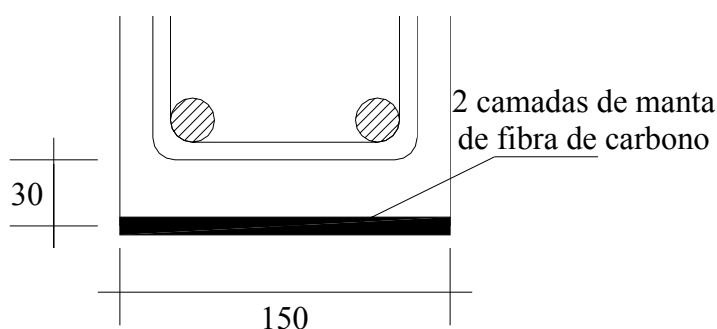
Detalhamento do reforço com manta de CFRP
